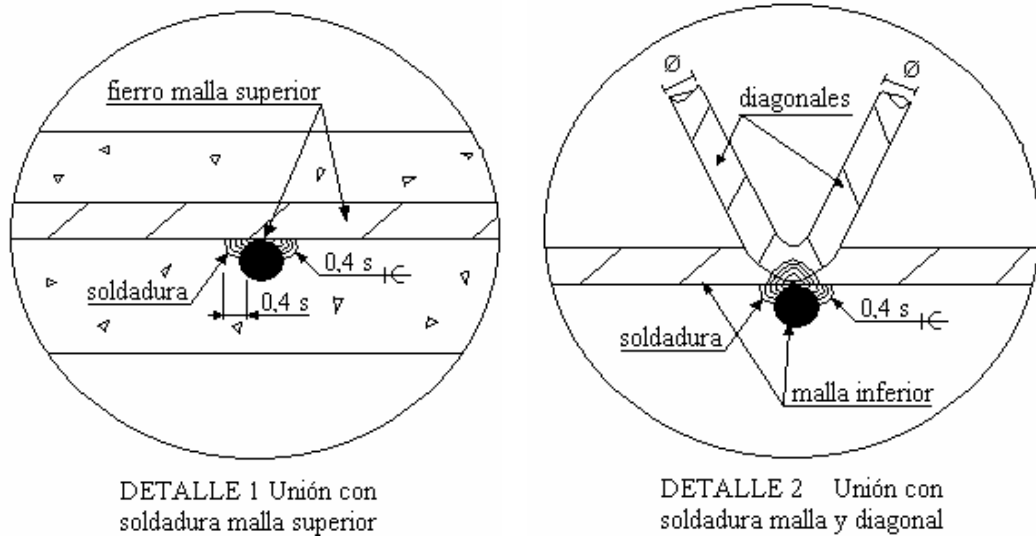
Detalles de unión soldada entre mallas y diagonales
